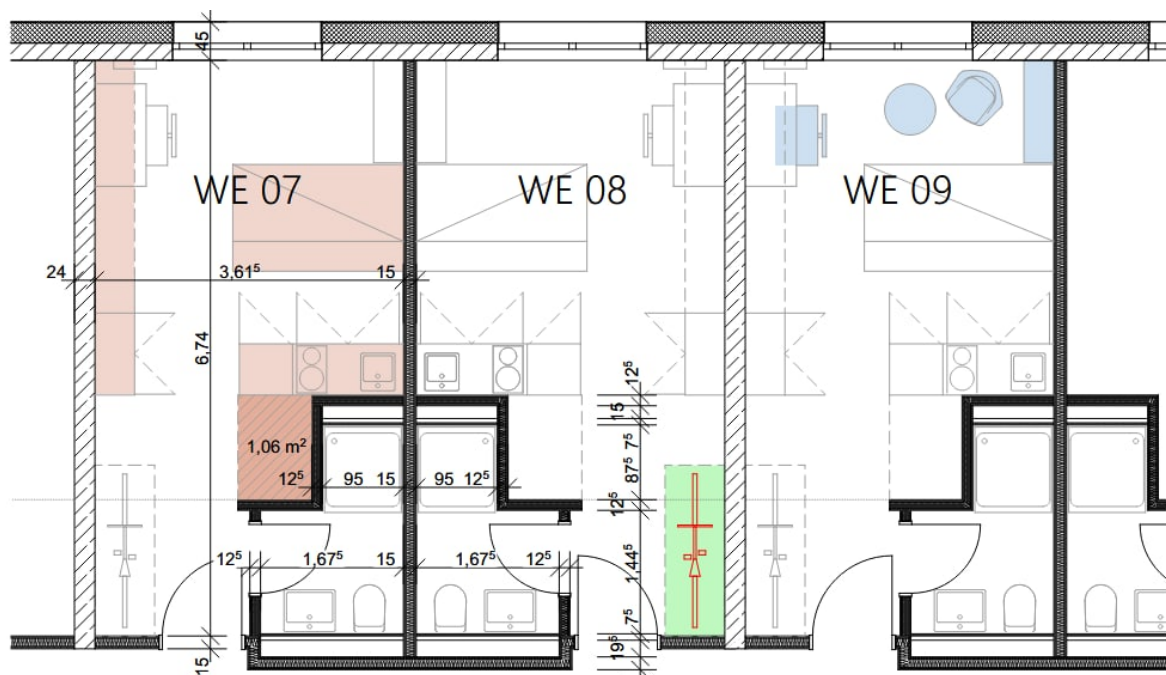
Regelgrundriss mit Fahrrad-Stellplatz
